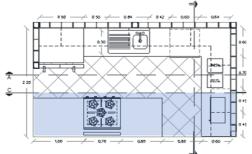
Diseño en alzado de cocina departamento torre Mitikah. Elaboración conjunta, Álvarez, González, Hurtado. 2022
